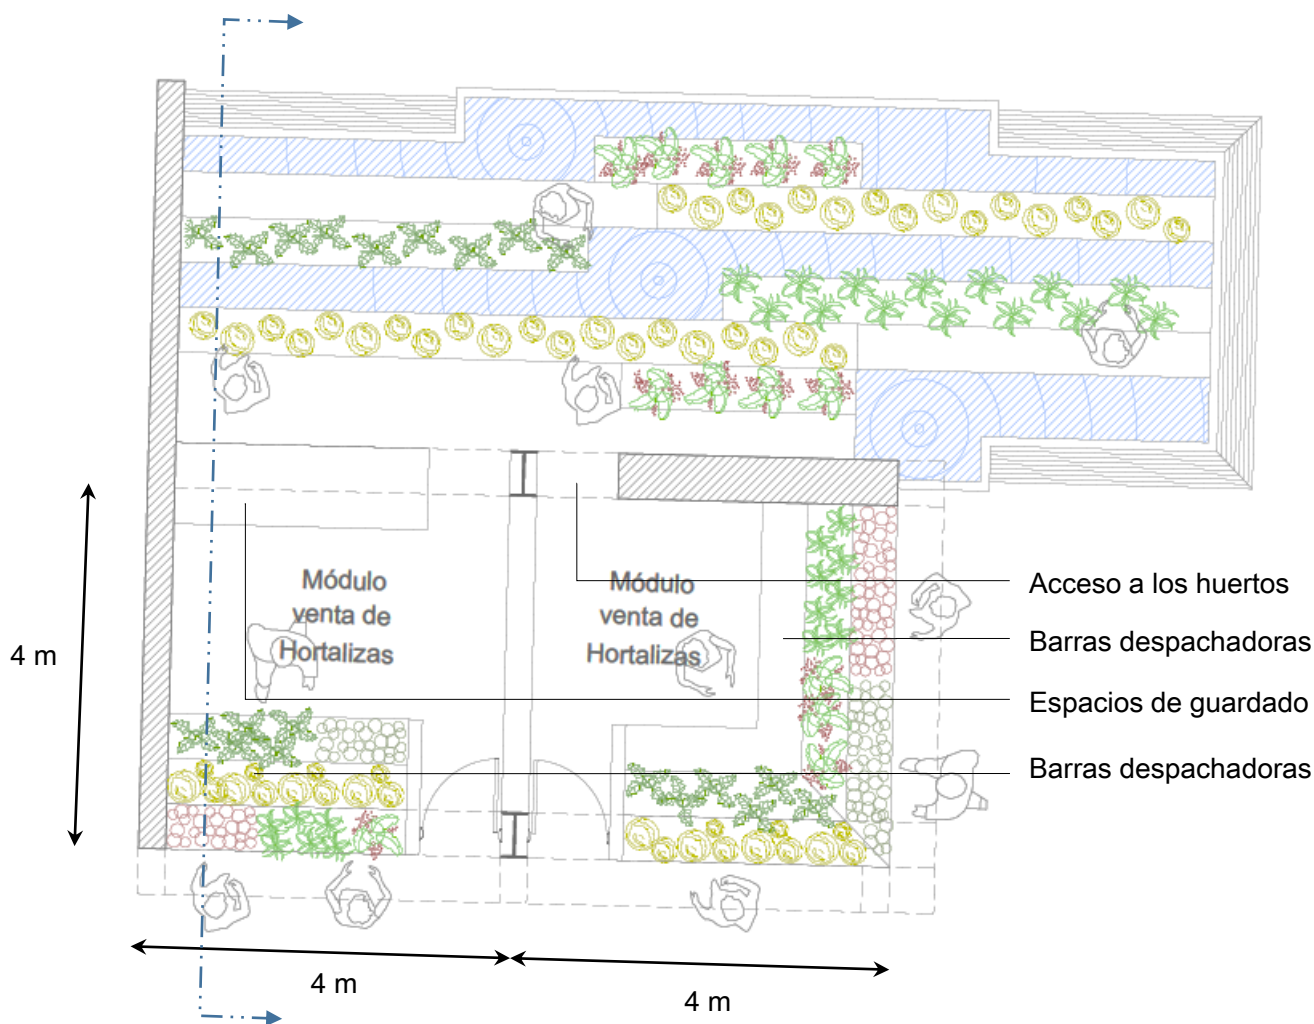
Planta de los módulos de venta de hortalizas y la relación directa con los huertos
